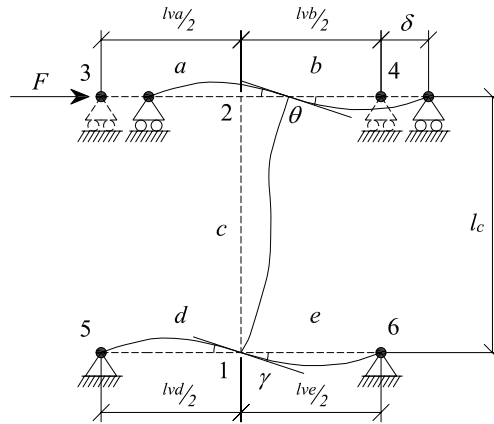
Modelo pilar- vigas virtuales en plantas superiores a la baja
